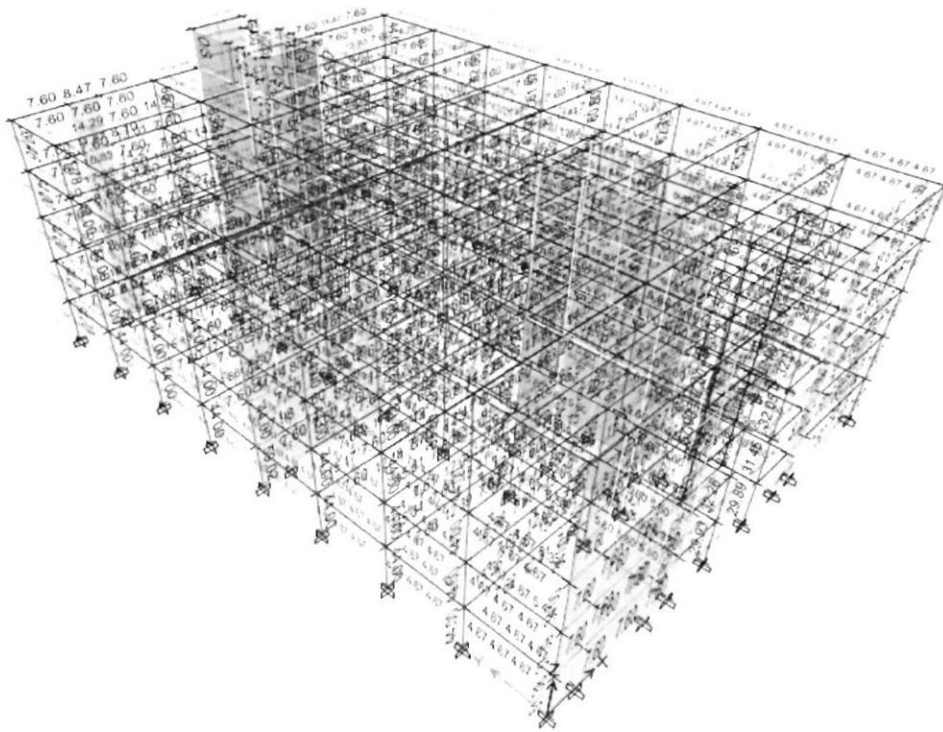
Vista de Cálculo Área Acero (cm²)
